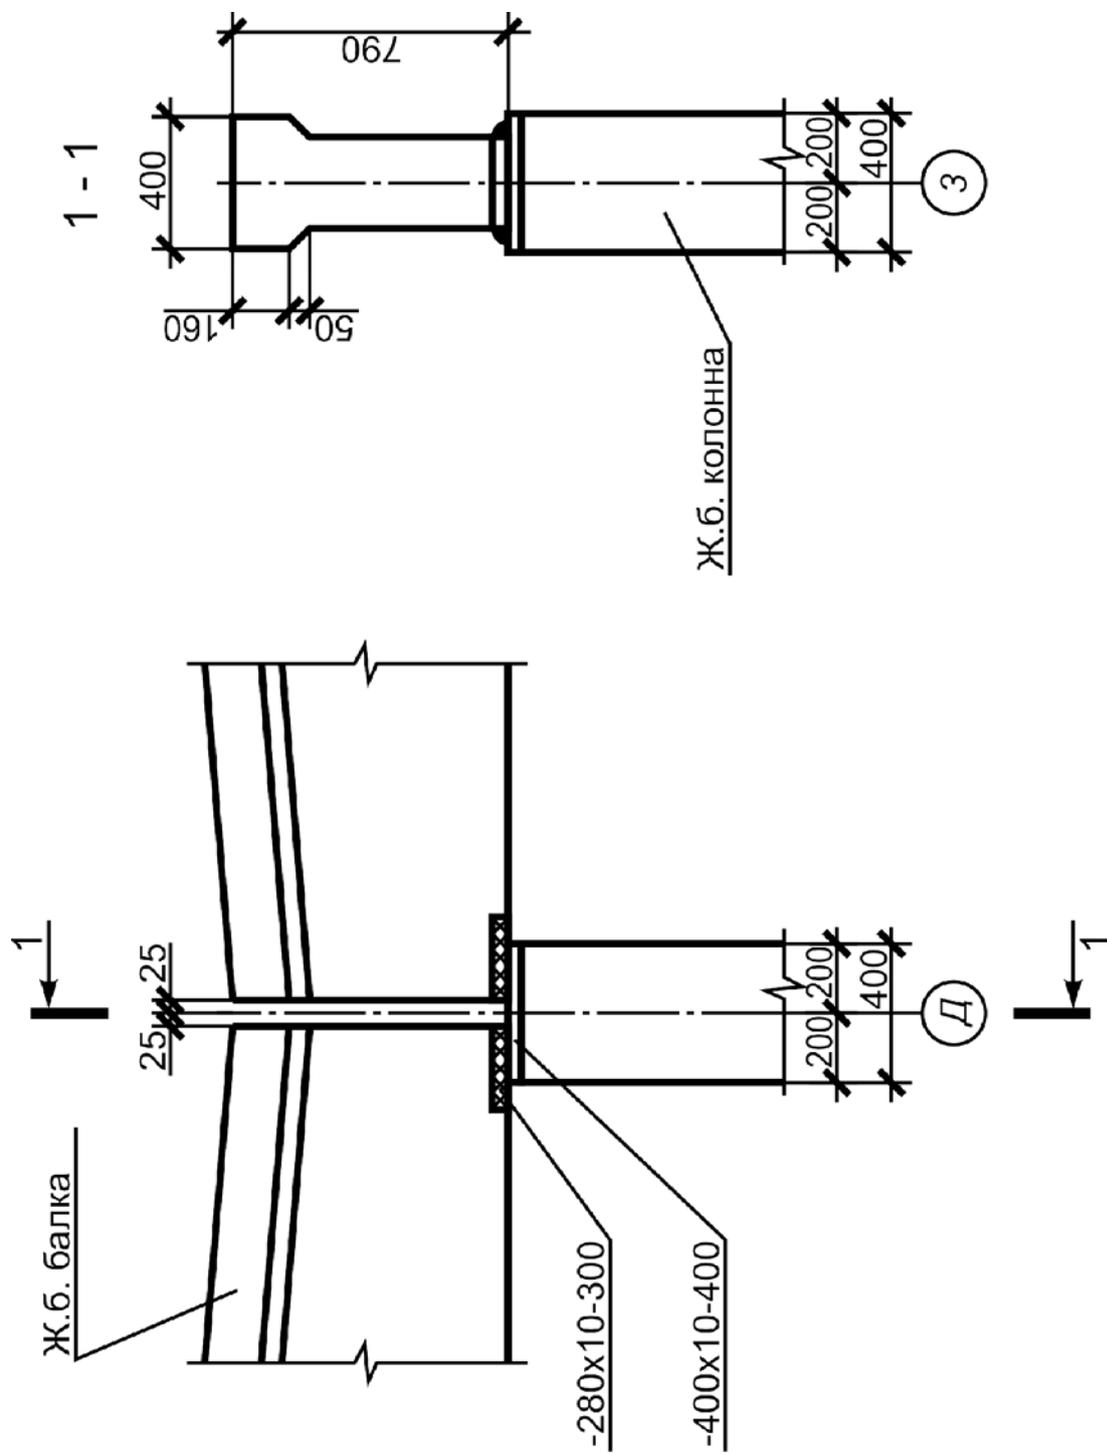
Опирание железобетонных балок покрытия на среднюю колонну
